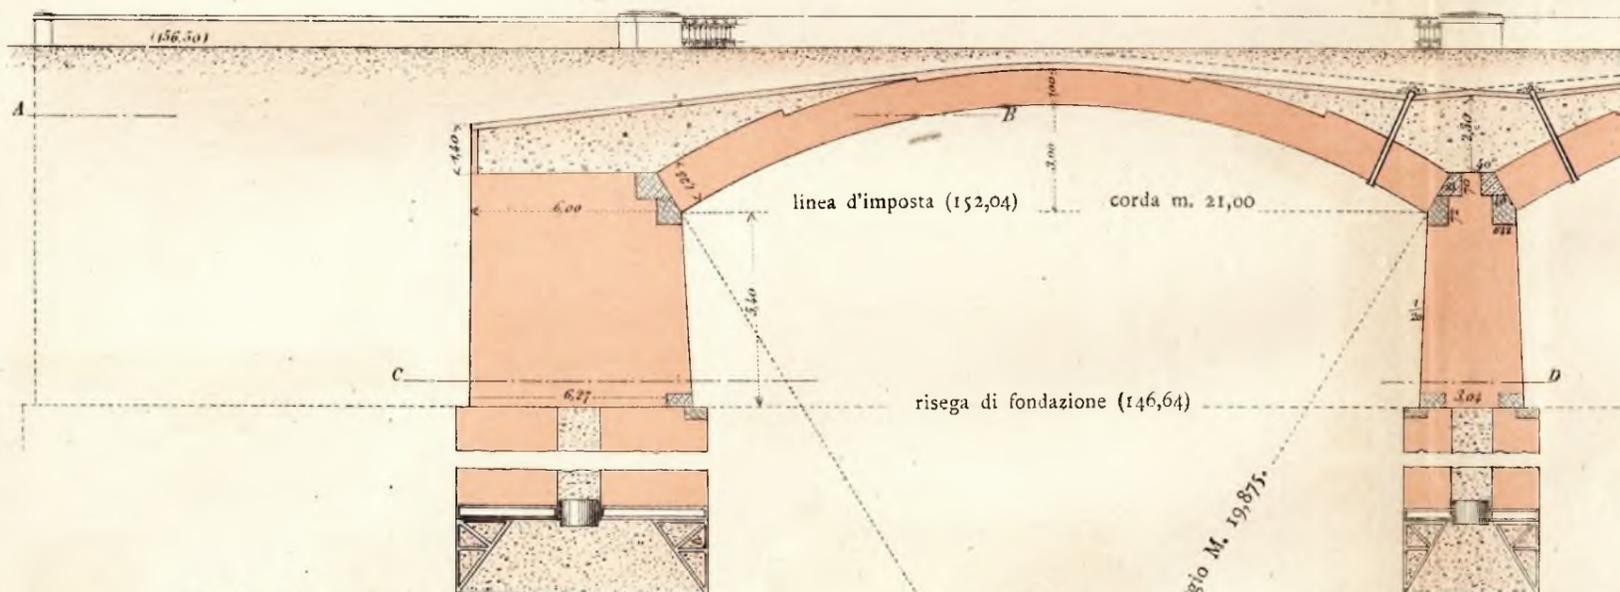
, 9. — Sezione trasversale presso una pila-spalla e pianta di questa.
